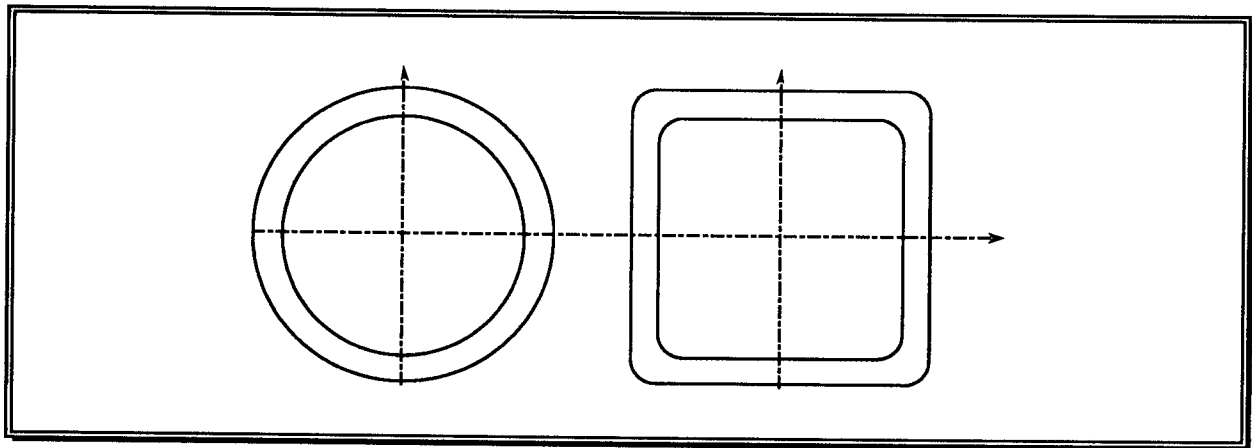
formes acceptables de section de poutres inter-UIAM
